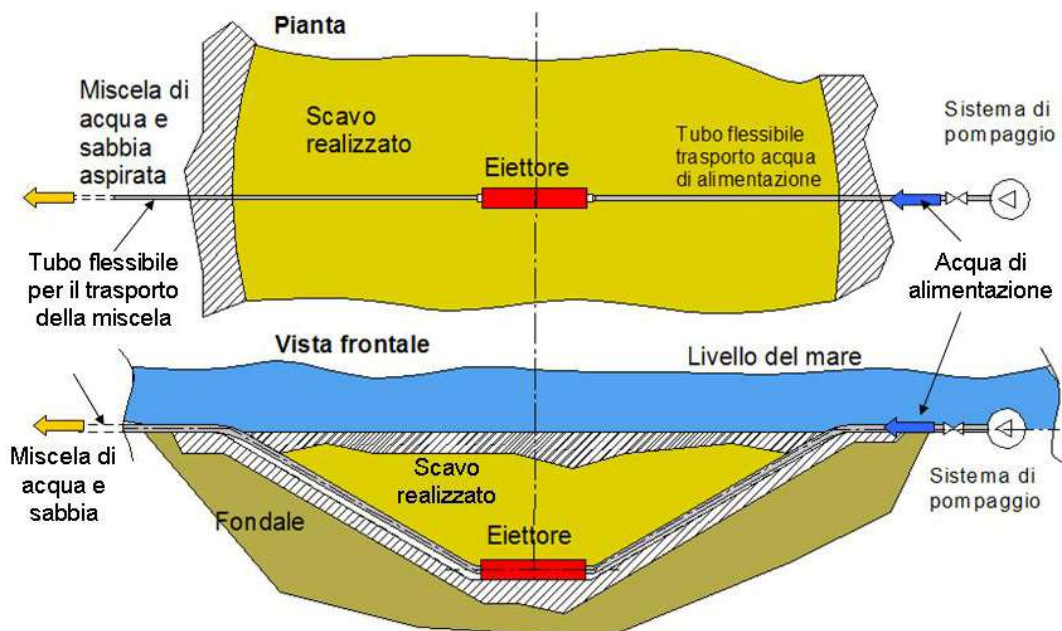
Visione in pianta ed in sezione di un eietttore.
